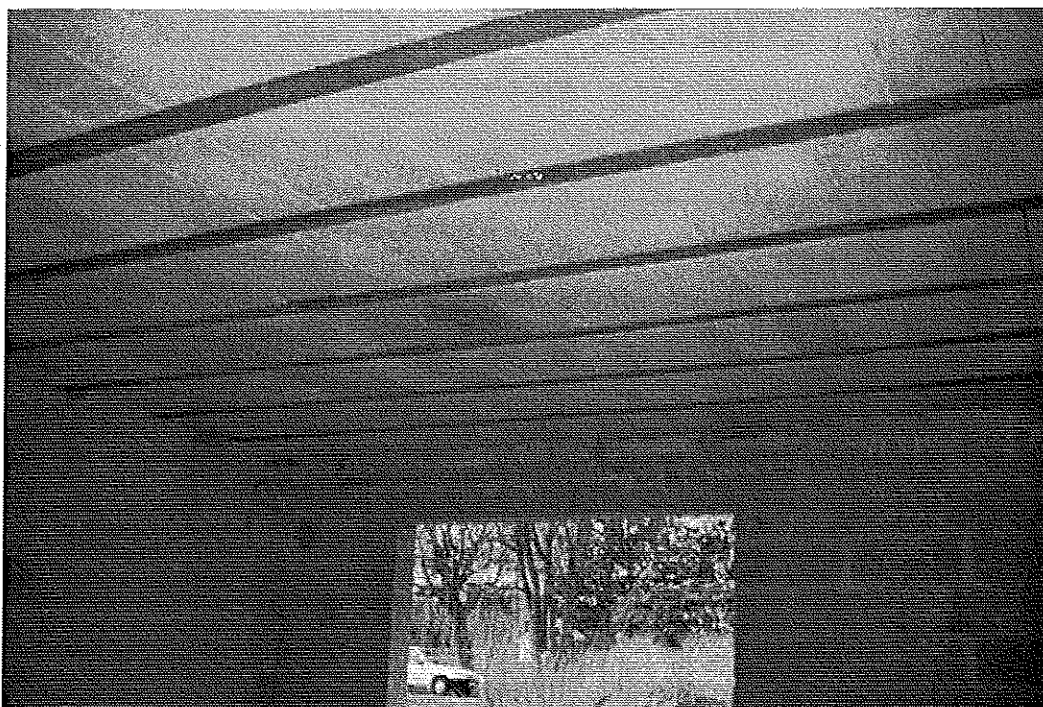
Plancher haut du rez-de-chaussée, travée courante entre refends transversaux porteurs.
